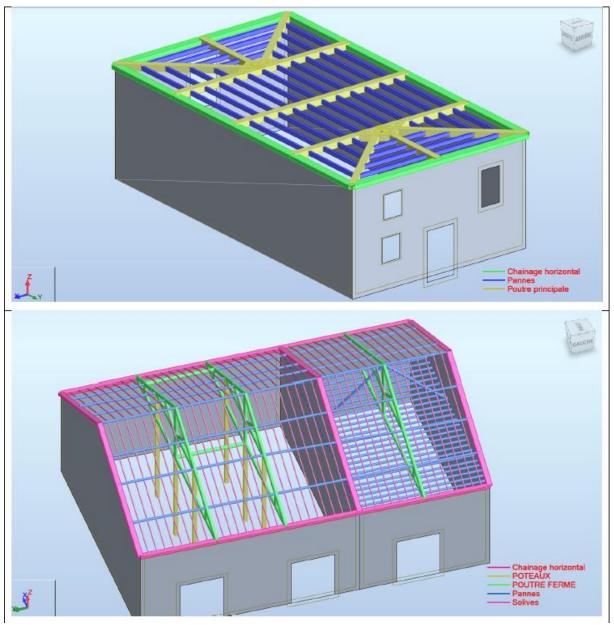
Plan de la mise en place des chainages horizontaux sur le bâtiment B004 (en haut) et sur le bâtiment B002 (en bas)
